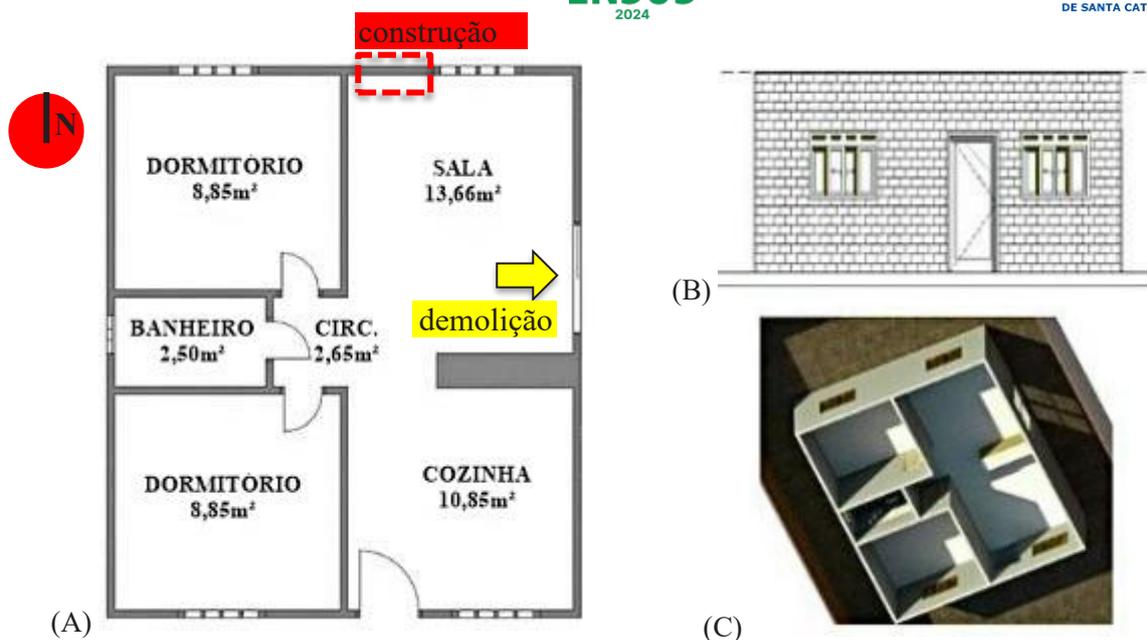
Projeto habitacional: (A) Planta baixa adaptada de acordo com as modificações de novas aberturas realizadas pelo morador, na planta original o acesso principal constava com 0,60 m, conforme delimitado com marcação vermelha tracejada, sendo substituída por vãos maiores, destacado com seta amarela; (B) Elevação, blocos de tijolos cerâmicos; (C) Perspectiva Interna. Fonte: elaborado pelos autores.
